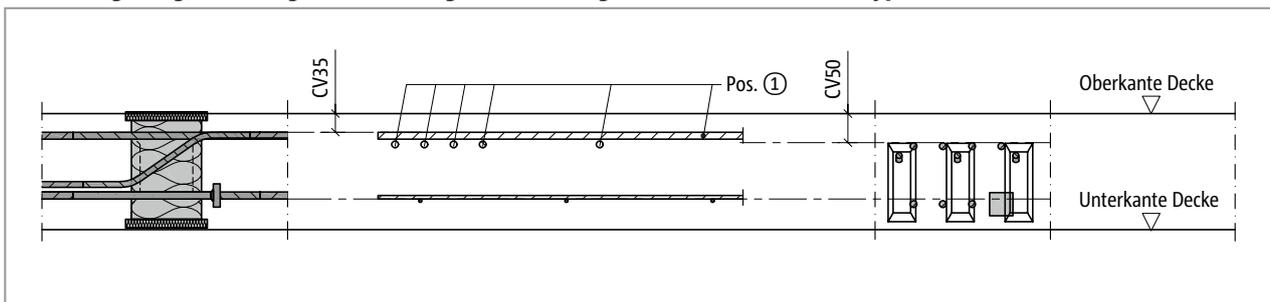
Schöck Isokorb® XT Typ C: Bauseitige Bewehrung Außenecke (Schnitt XT Typ C-L-CV35, Ansicht XT Typ C-R-CV50)
